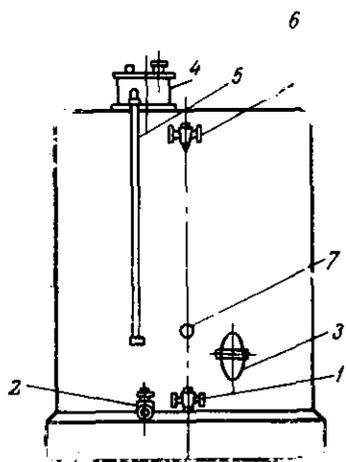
Схема оборудования железобетонного резервуара комплектом арматуры ВАЖР-4:
